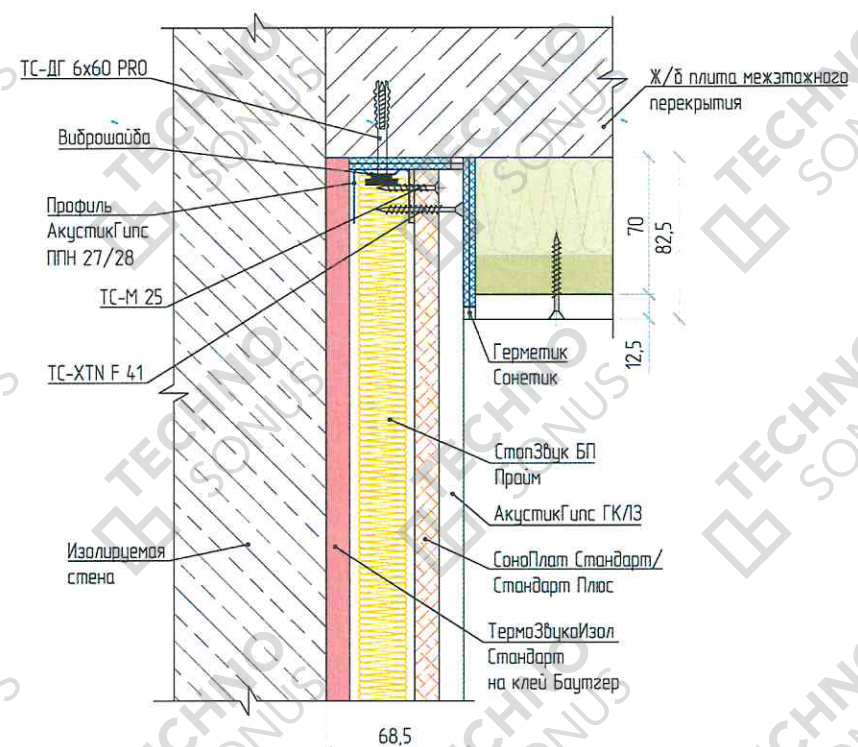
Примыкание звукоизолирующего потолка «Слим А2» к звукоизолирующей облицовке стены ТС-2.2
